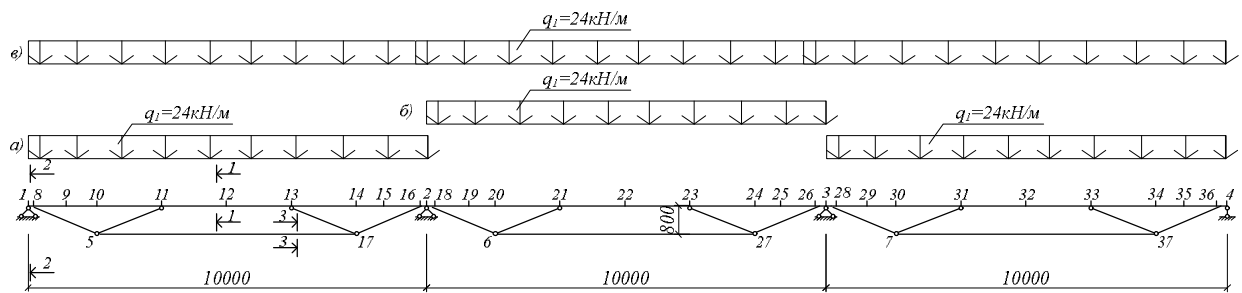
Схеми завантаження нерозрізної комбінованої конструкції: а – схема завантаження крайніх прольотів постійним навантаженням металевої конструкції – стадія I; б – схема завантаження середнього прольоту постійним навантаженням сталезалізобетонної в крайніх і металевої в середньому комбінованої конструкції – стадія II; в) схема завантаження прольотів постійним і корисним навантаженням сталезалізобетонної комбінованої конструкції – стадія III
